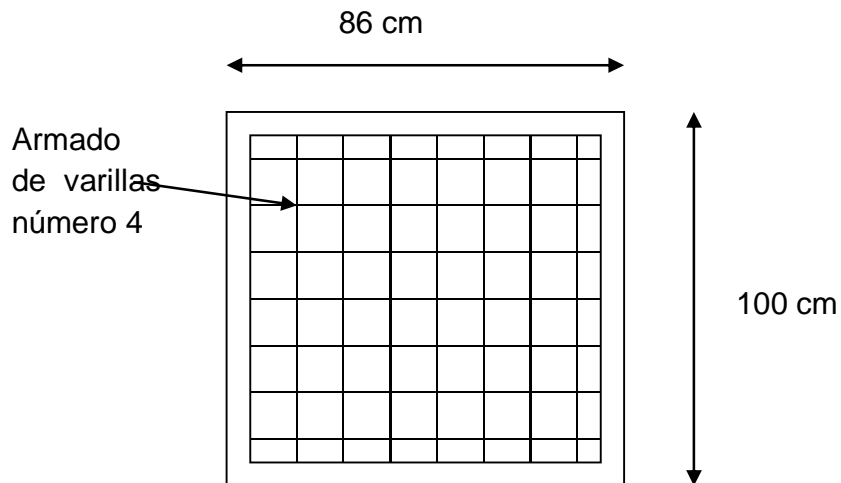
Armado transversal del pilastrón
